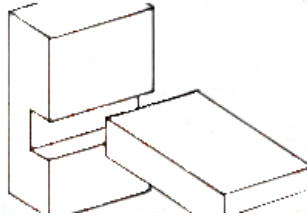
Ensamble de horquilla en ángulo recto con espiga abierta
